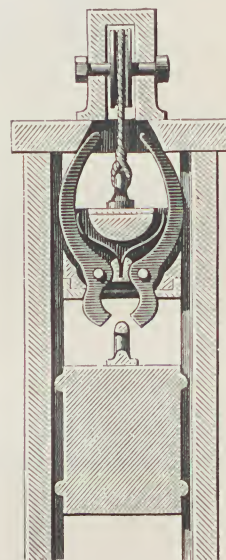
Detalle del mecanismo de los motones de mordaza
